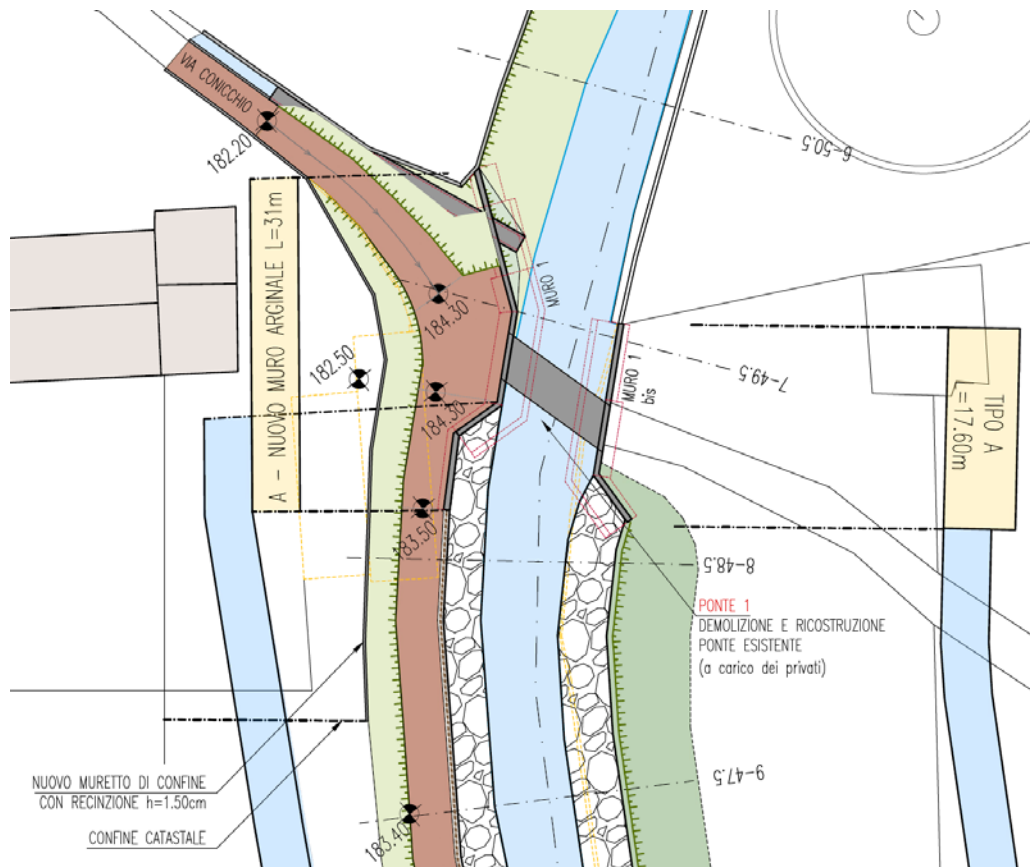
Estratto Tavola 04. Planimetria del muro 1.
